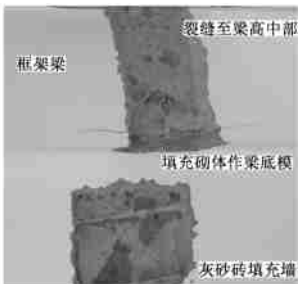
砌体墙裂缝延伸至混凝土构件上
